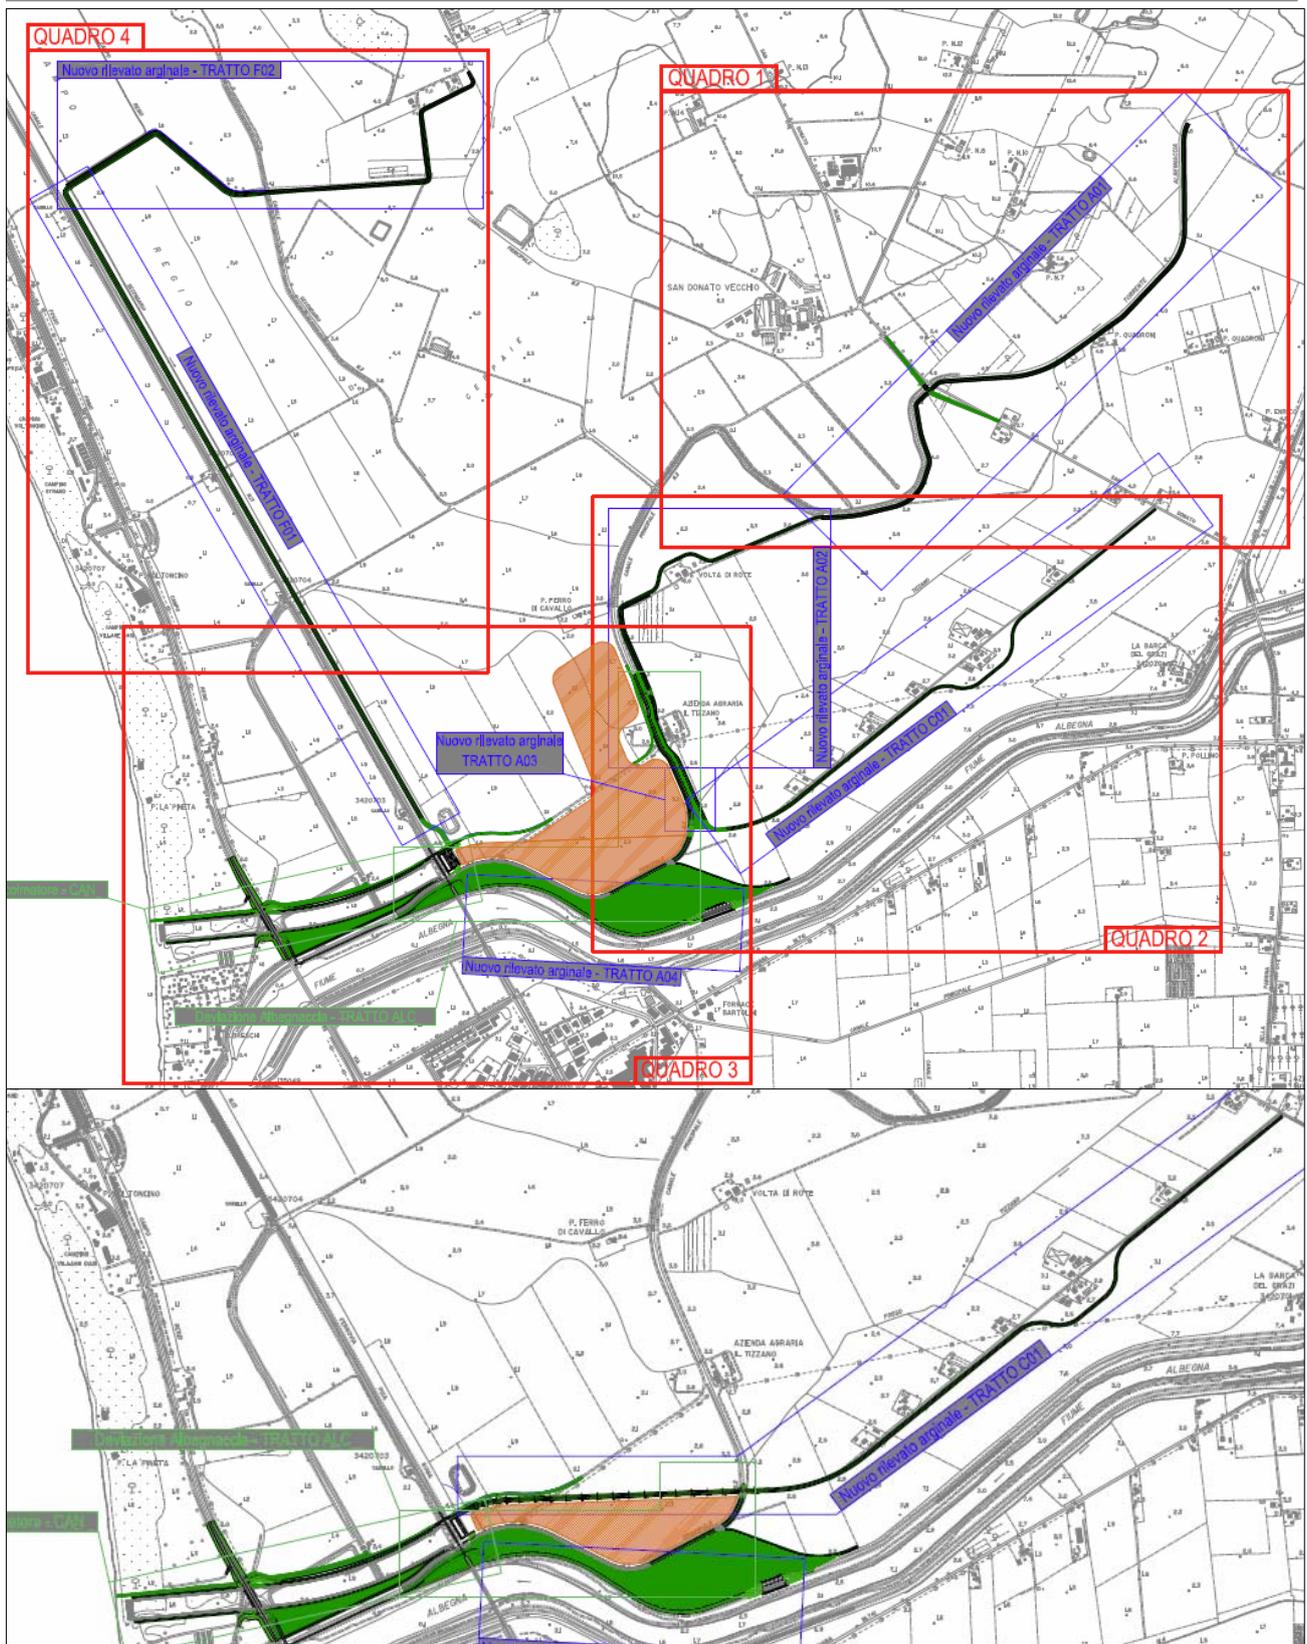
Planimetria di progetto della Cassa d'espansione e del Canale Scolmatore. Progetto generale e 1° Stralcio funzionale
